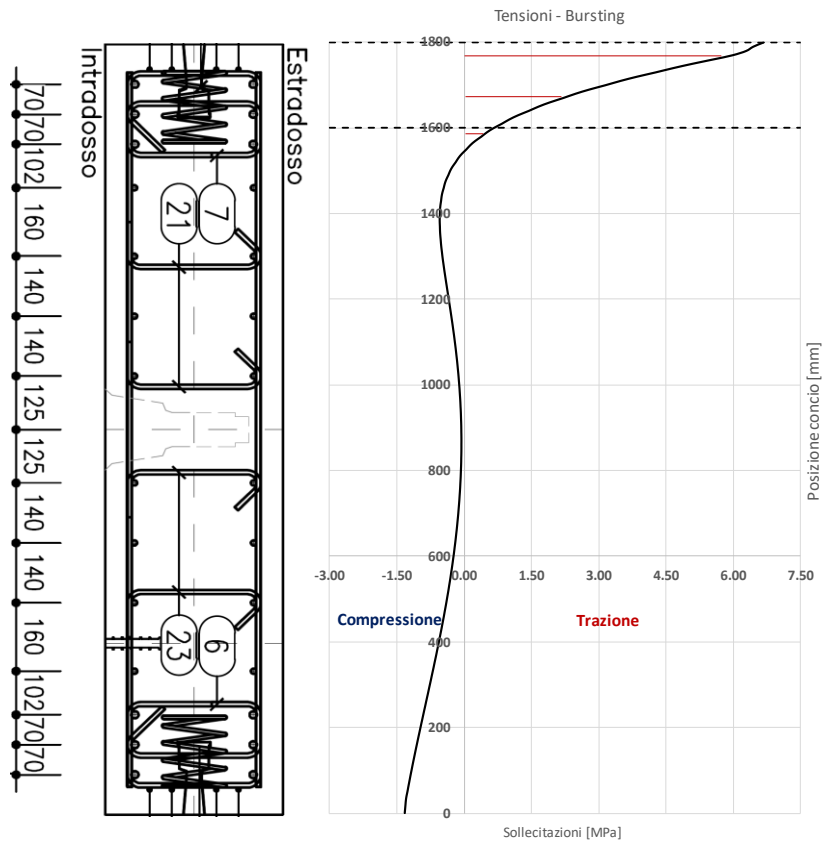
Andamento delle sollecitazioni effetto spalling tra le scarpe di spinta
